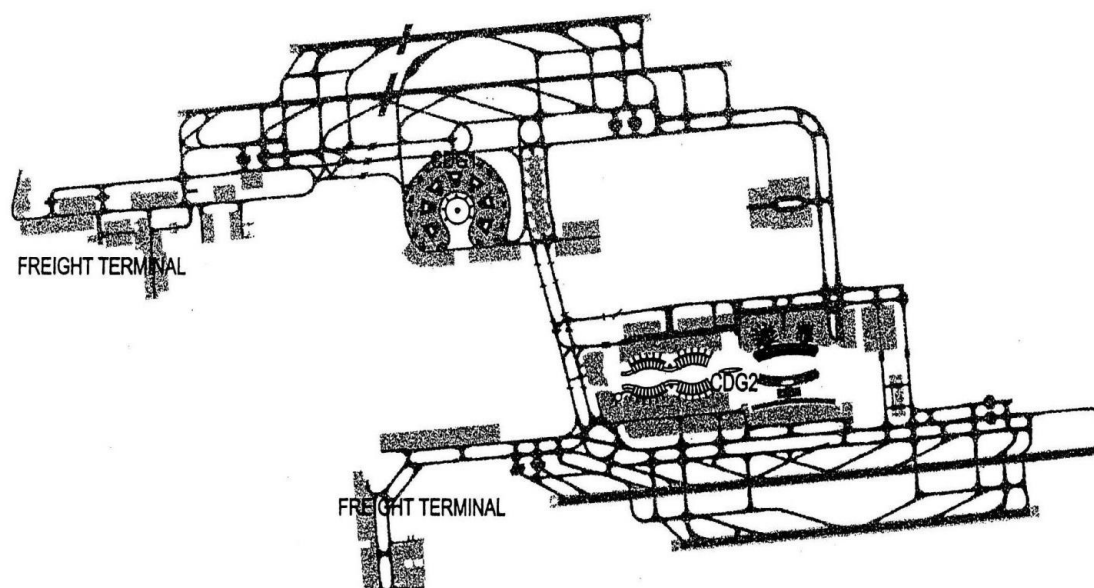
Генеральный план аэропорта Шарль Де Голь
